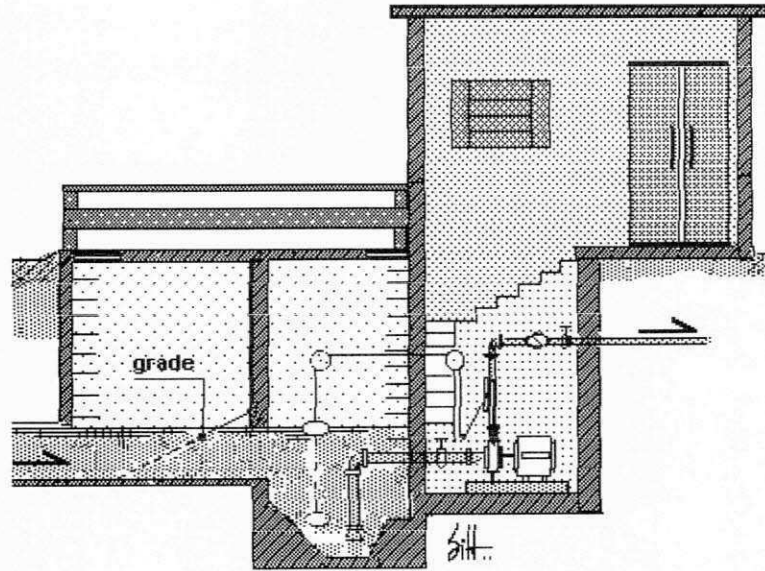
Elevatória com bombas de eixo horizontal
